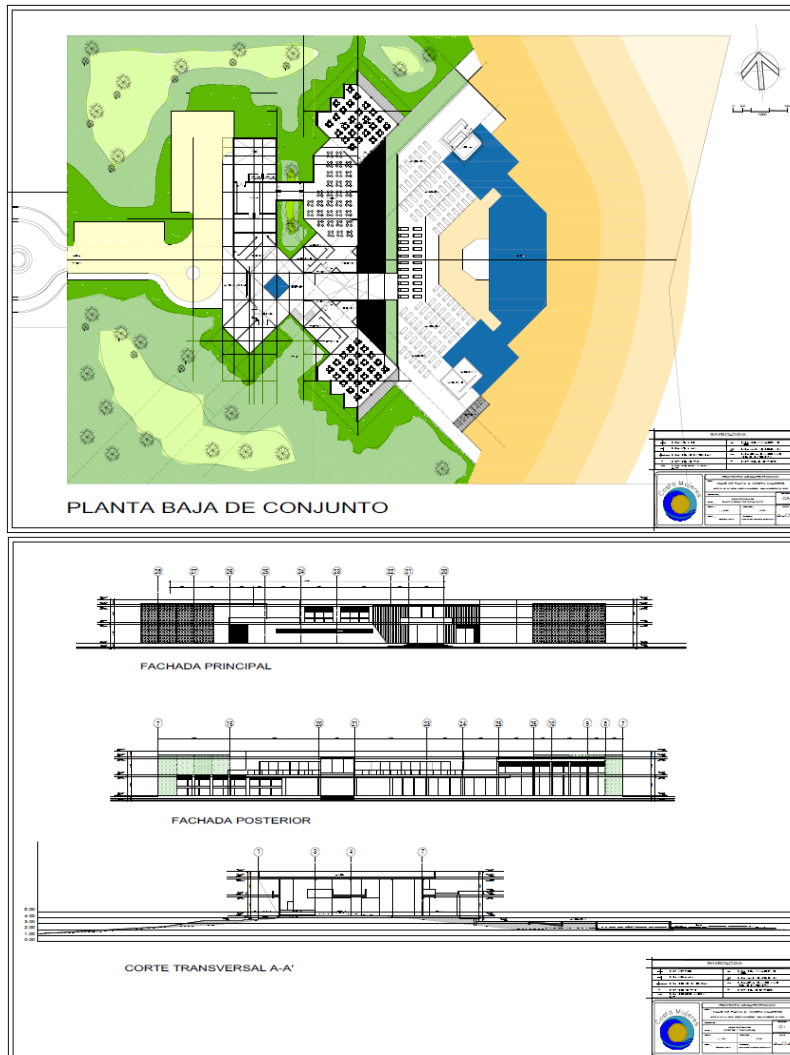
Diseño arquitectónico en detalle del segundo de los Club de playa.
